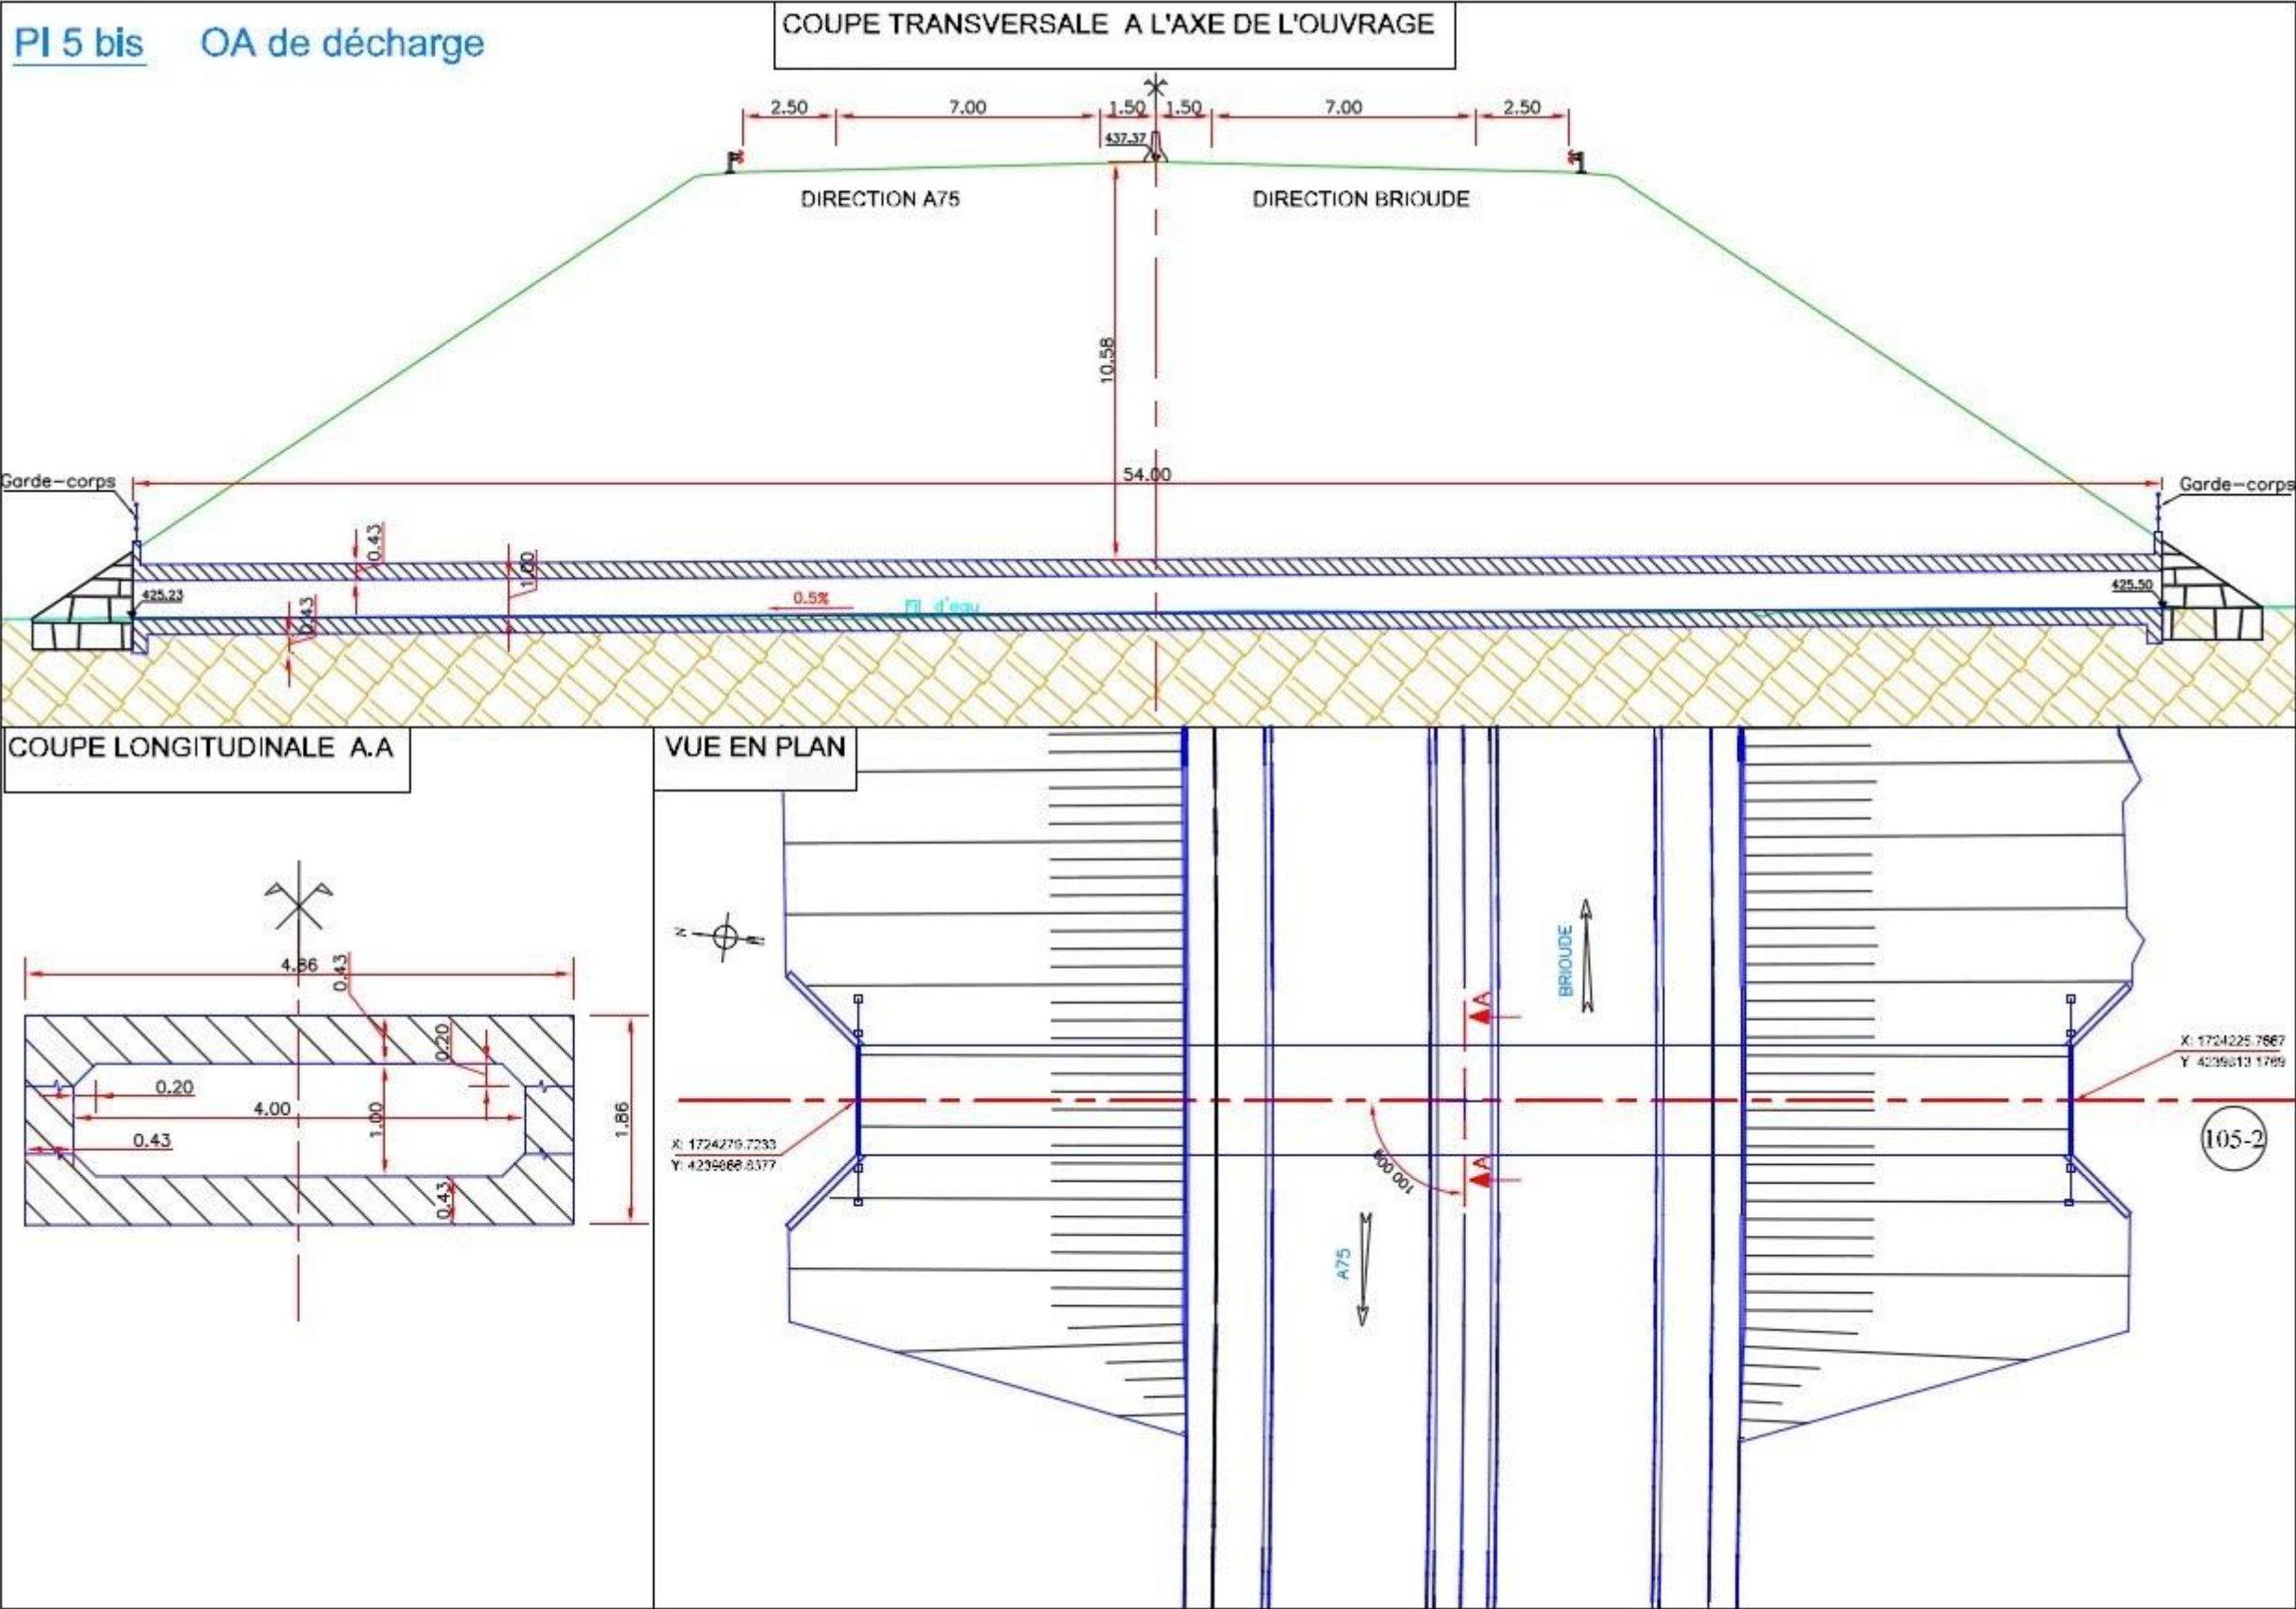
COUPE EN TRAVERS DE L'OUVRAGE SUR LE RUISSEAU DE BARLIERES
